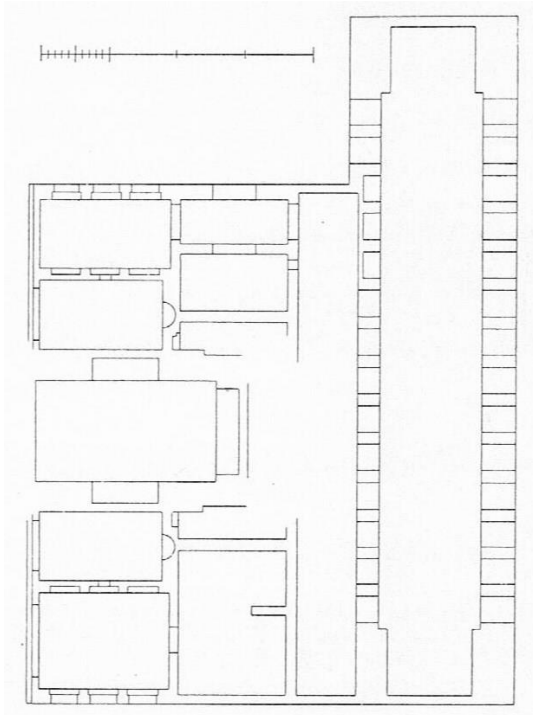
Grundriss des Stadtgymnasions
